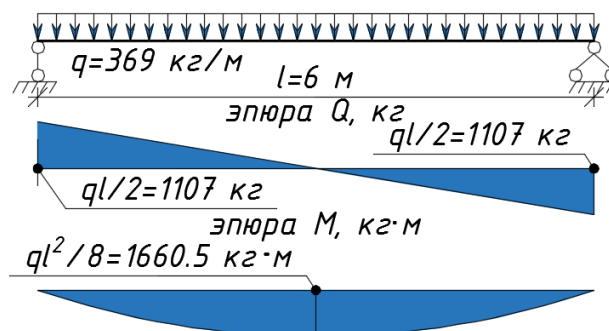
Сбор нагрузок на балку, расчетная схема балки при использовании заполнения из блоков ракушечника – местного строительного материала для Крыма
